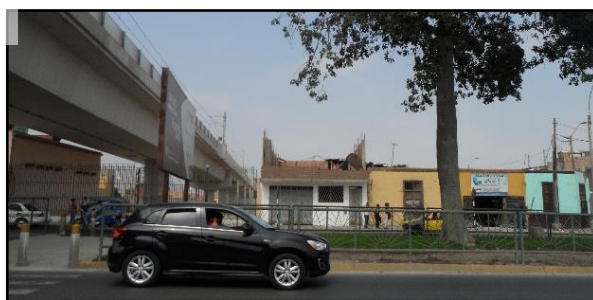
Av. Ancash, ingreso al terreno donde se puede visualizar la Vía del Metro de Lima y la venta de Marmolería.
